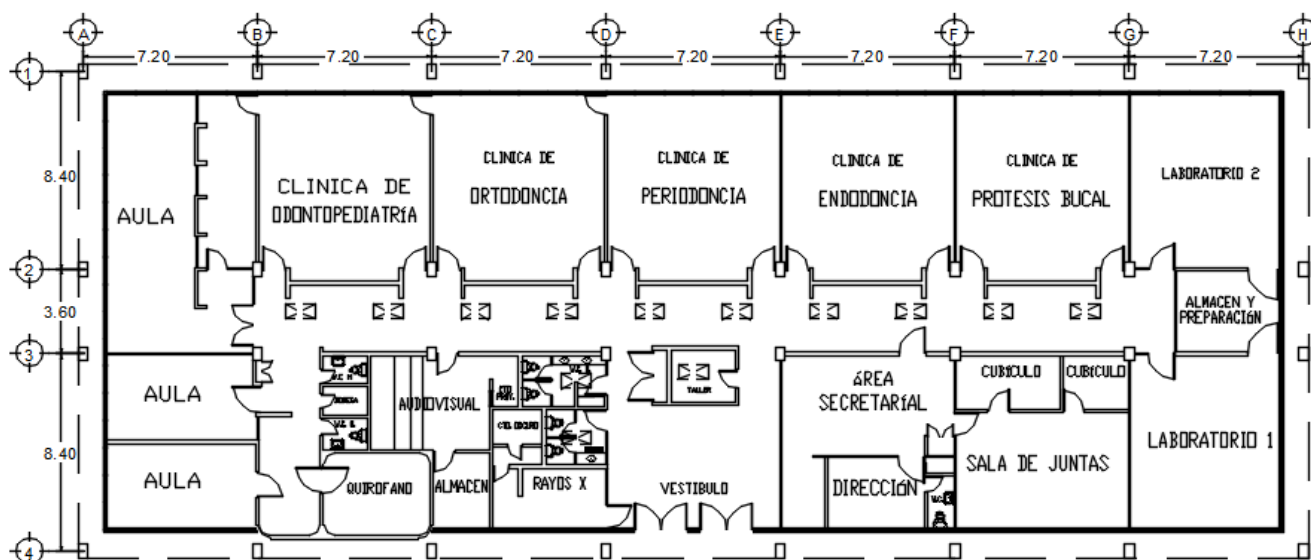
Esquema de la geometría en planta de la edificación de estudio.
